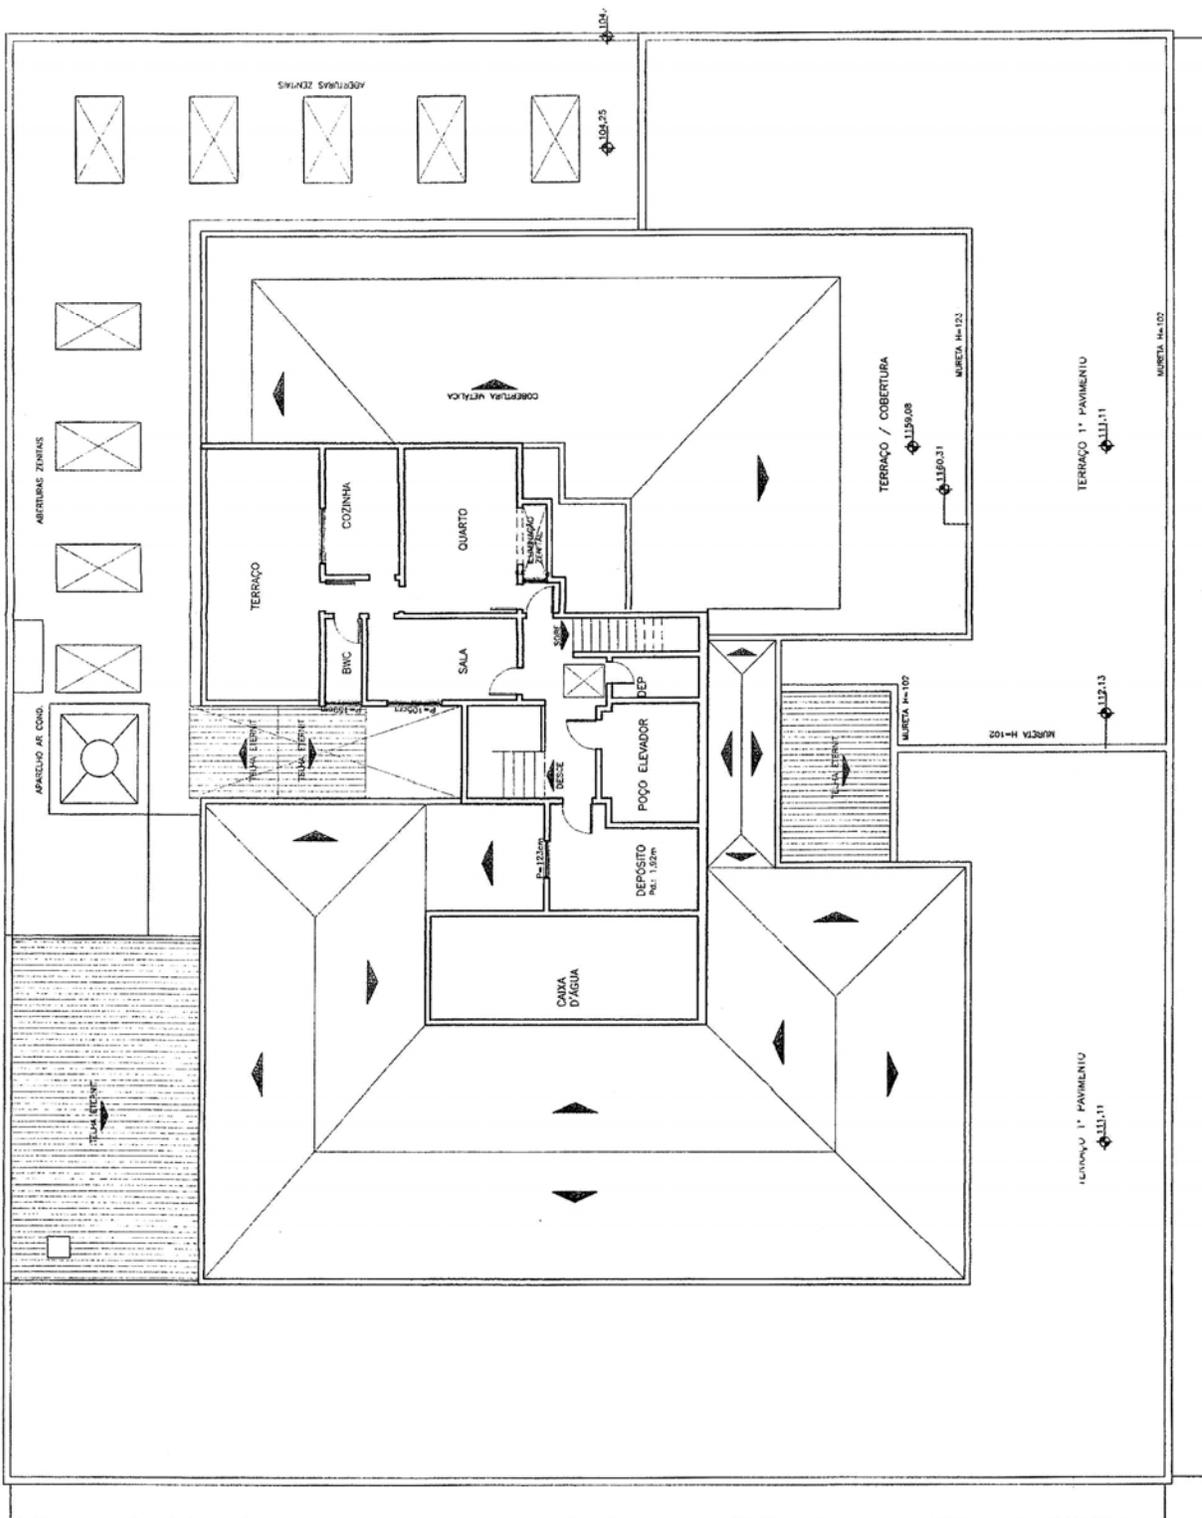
Planta baixa do pavimento do apartamento de zelador (sem escala) do edifício EC 3
